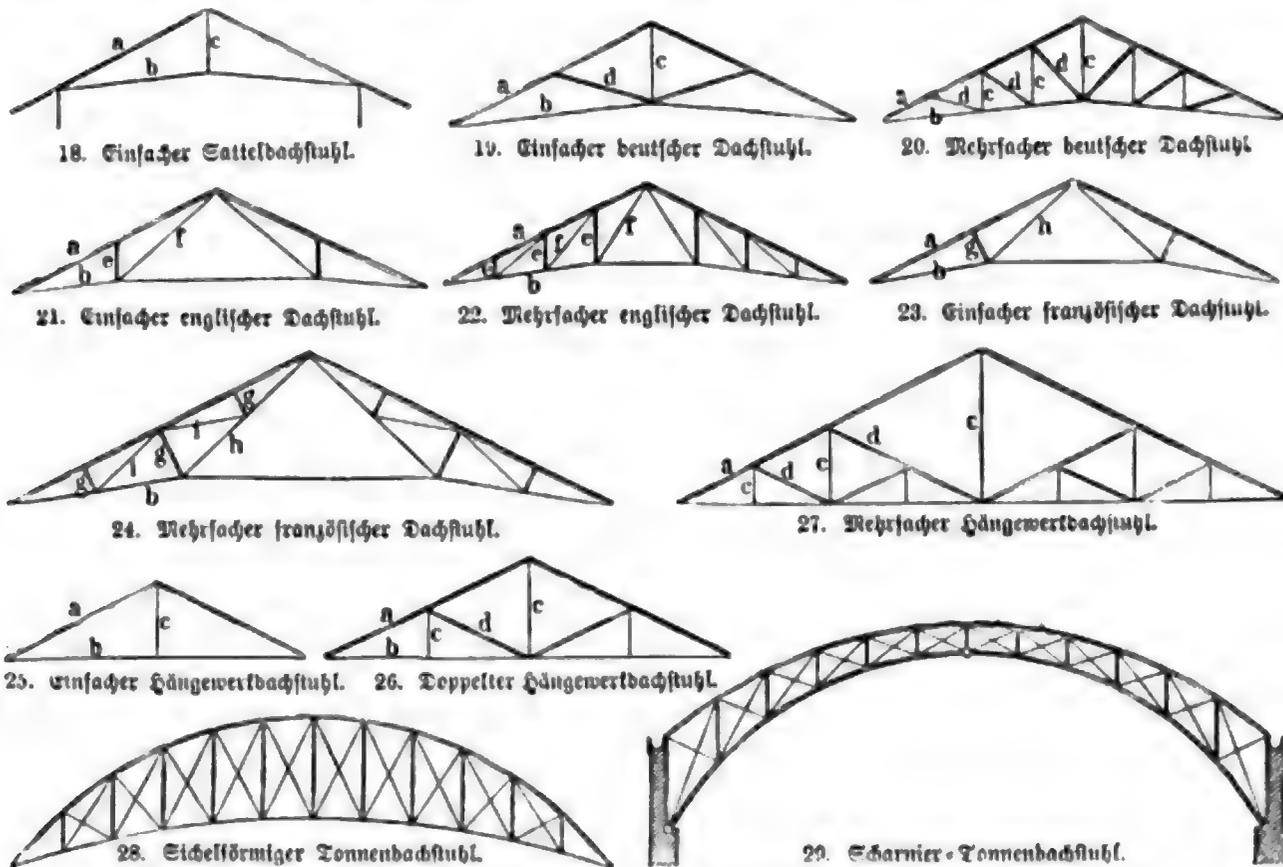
27. Eiserne Dachstühle mit geraden, Fig. 28 u. 29 mit gekrümmten Sparren.
